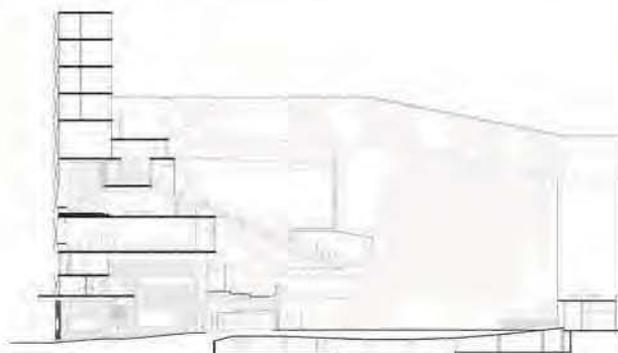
Corte longitudinal con tres volúmenes de fachada, hacia corredores al acceso del edificio.
